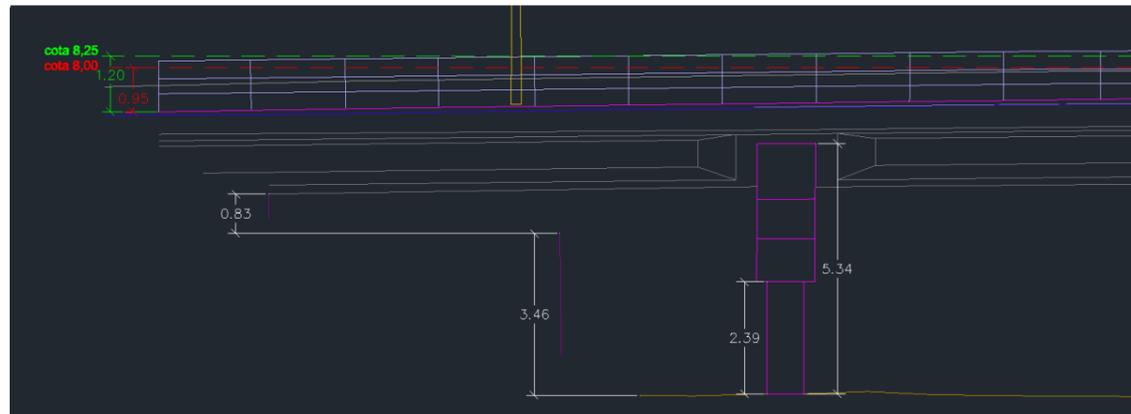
Detalle margen izquierda. Altura necesaria murete (95 cm) para alcanzar cota 8,00 msnm.
